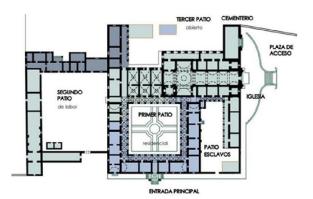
Saborido Forster, (2019) Planimetría CAD. Hacienda de Sta. Catalina [imagen]. Sevilla: Univ. de Sevilla.
